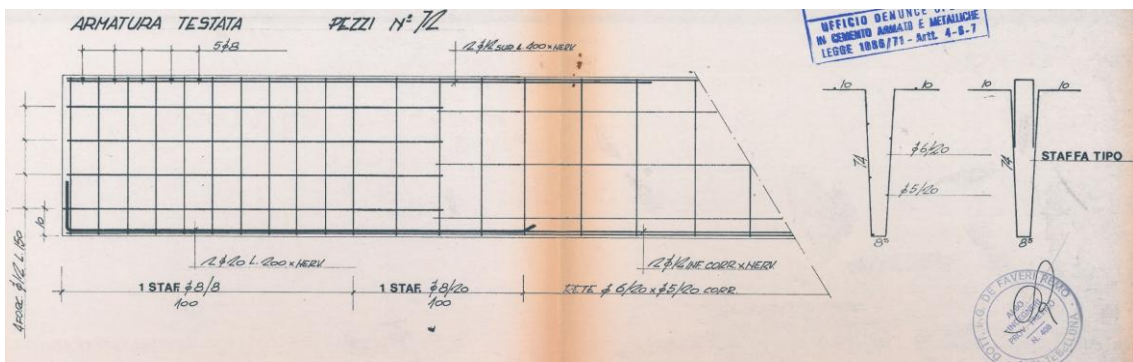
Particolare di A.1990.cap.us.T16 - Armatura tegolo h 78-10,5 - Sezione longitudinale
